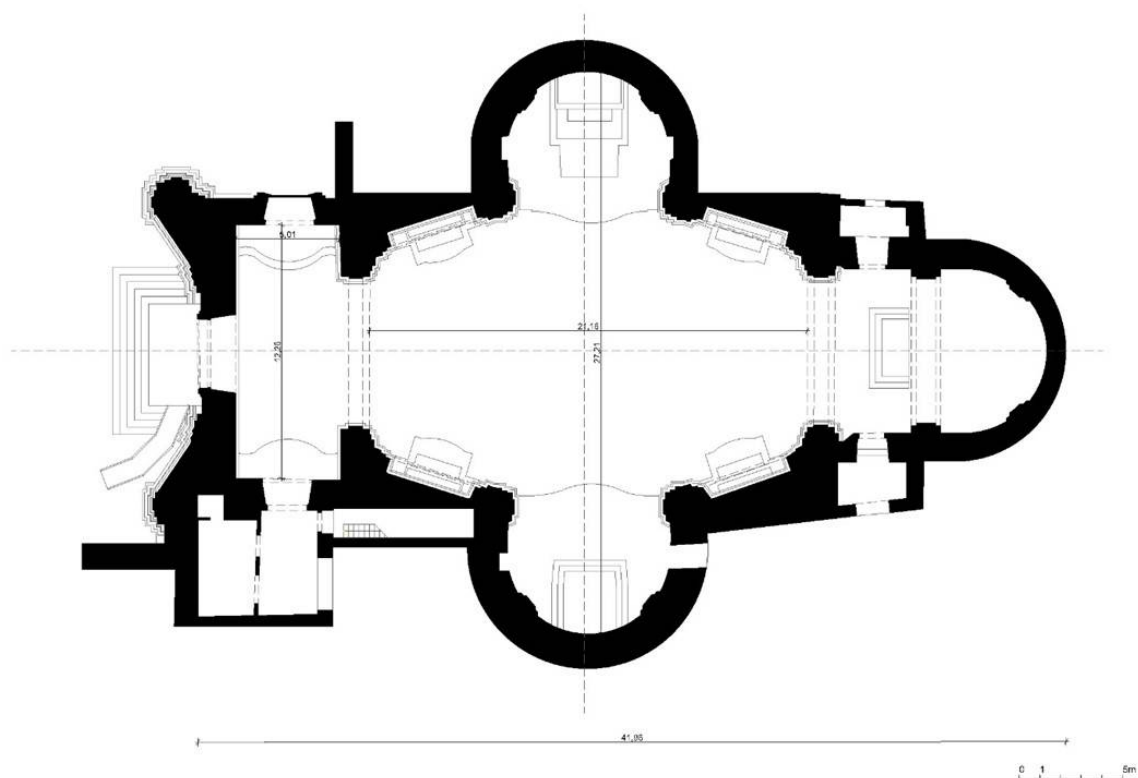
Pianta, chiesa Santa Maria del Carmelo in Noto
